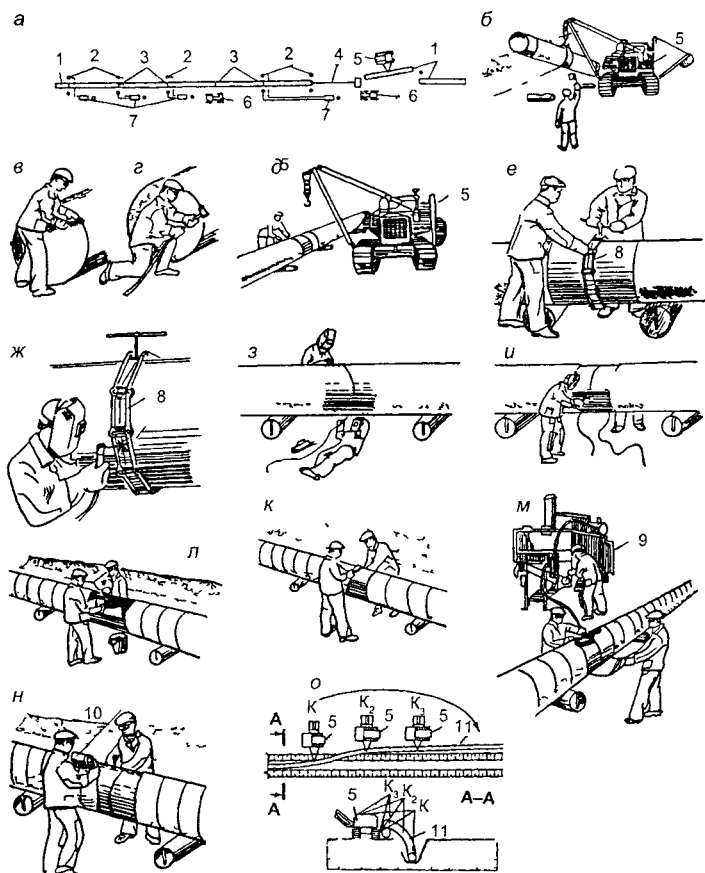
Сборка и сварка изолированных труб и секций в плети и укладка их в траншею :
